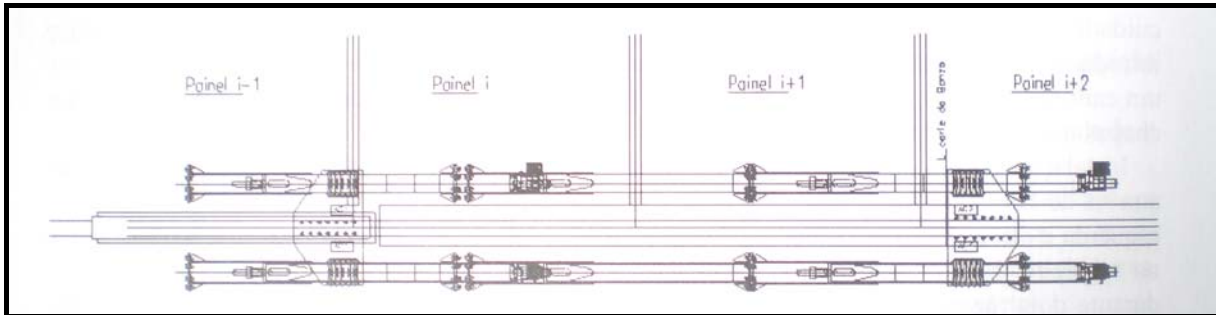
Estrutura provisória para a substituição das chapas de banzo [39]
